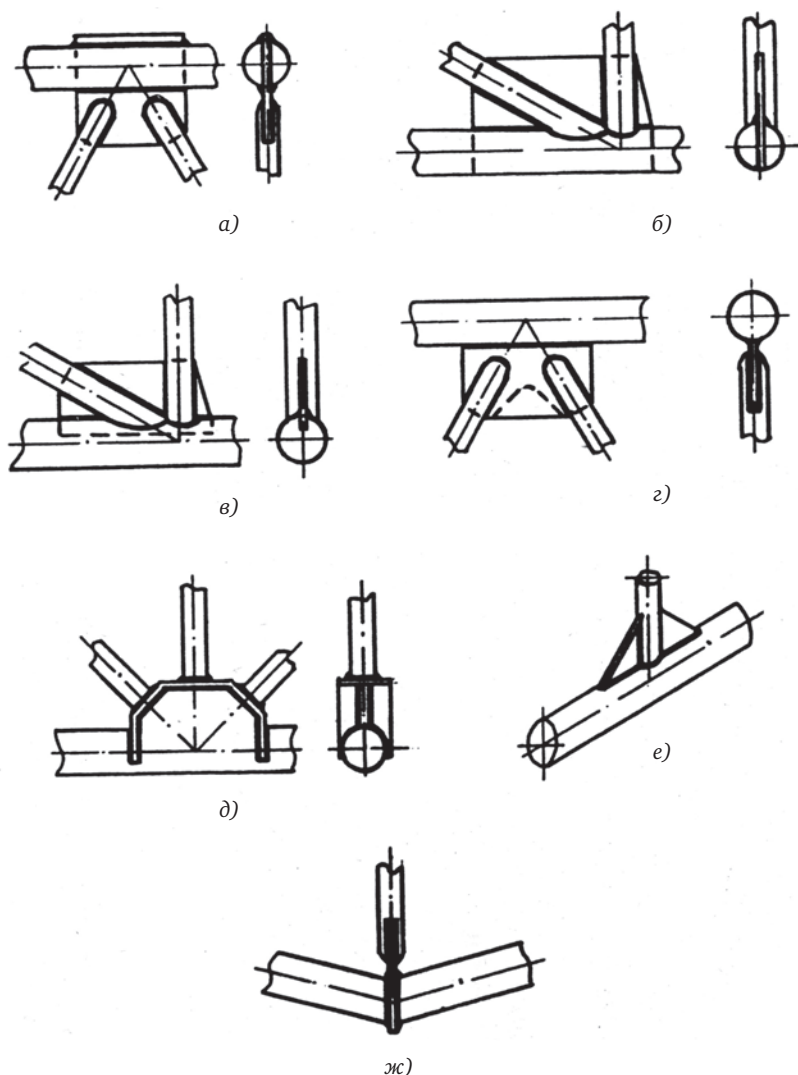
Схемы соединений трубчатых стержней с фасонками:
